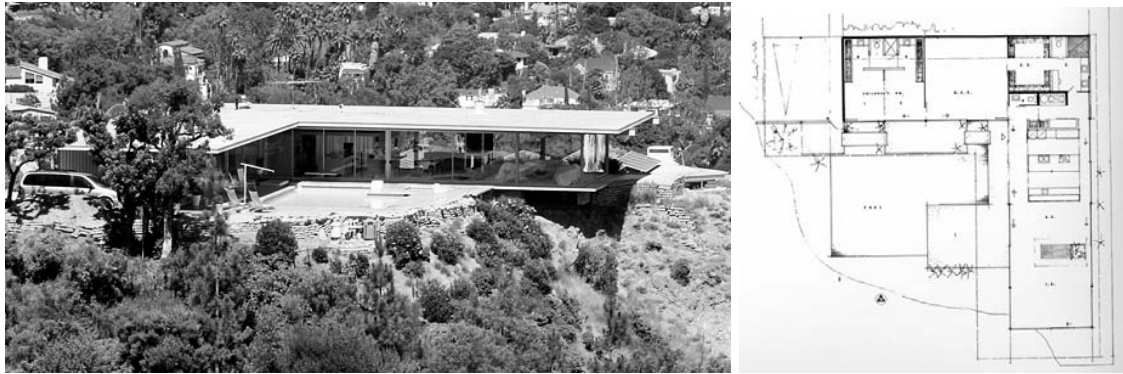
PIERRE KOENIG, CSH#22, West Hollywood, 1958-1960. (vista exterior e planta)
